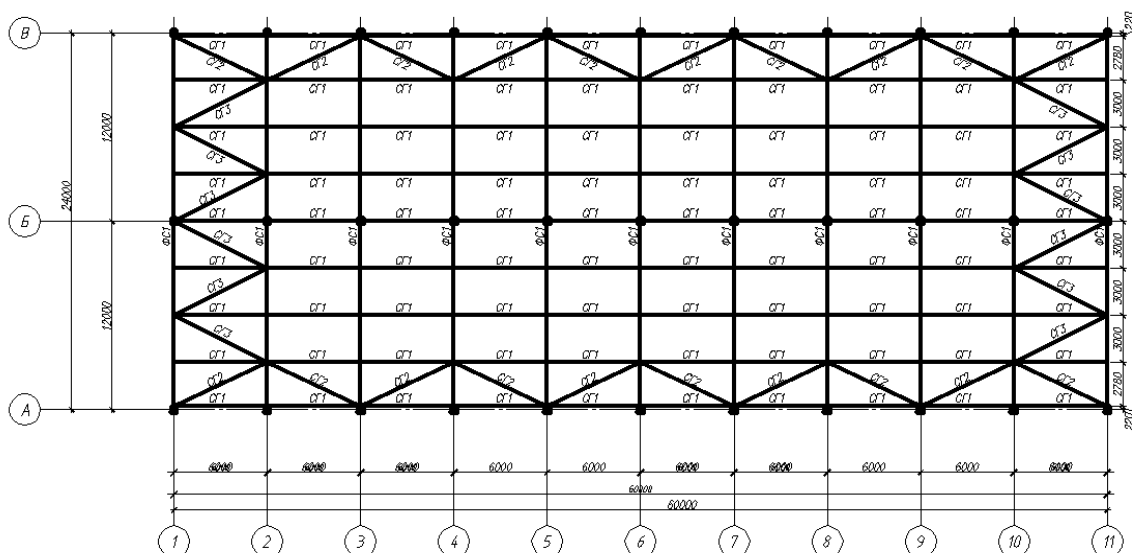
Схема расположения стропильных ферм и связей по нижним поясам ферм
